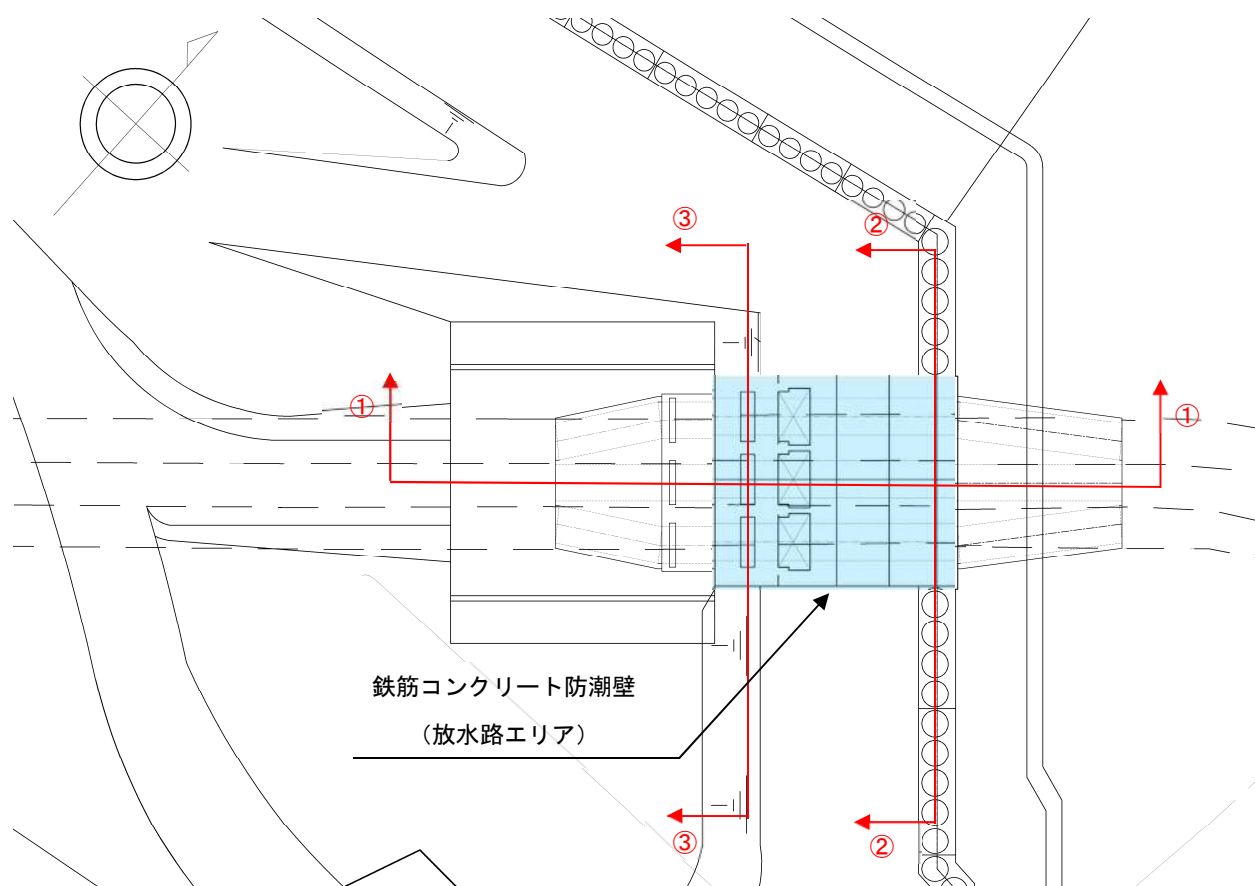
鉄筋コンクリート防潮壁（放水路エリア）の平面図
